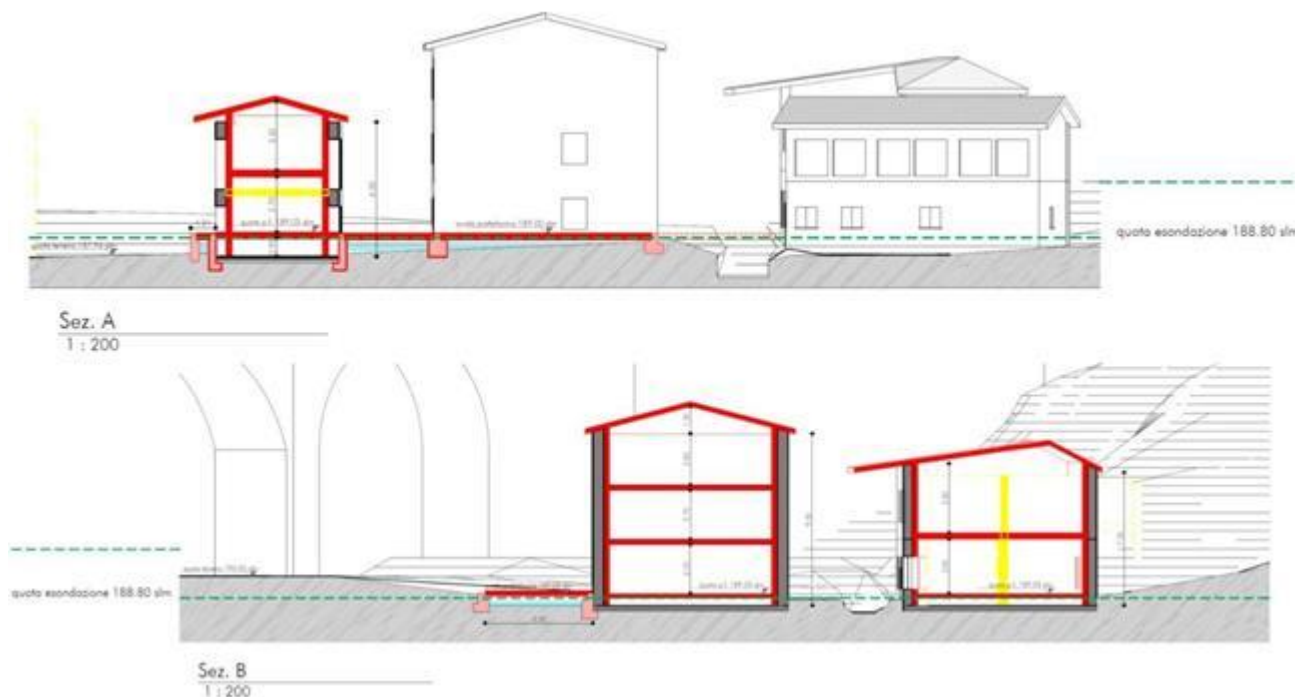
stralcio tavola 13 del piano di recupero, "Planimetria generale di progetto e sezioni edifici da recuperare"
